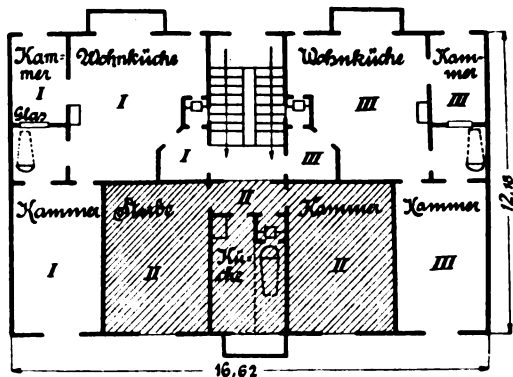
Grundriß eines Hauses mit 2 durchlüftbaren und 1 nicht durchlüftbaren Wohnung.
